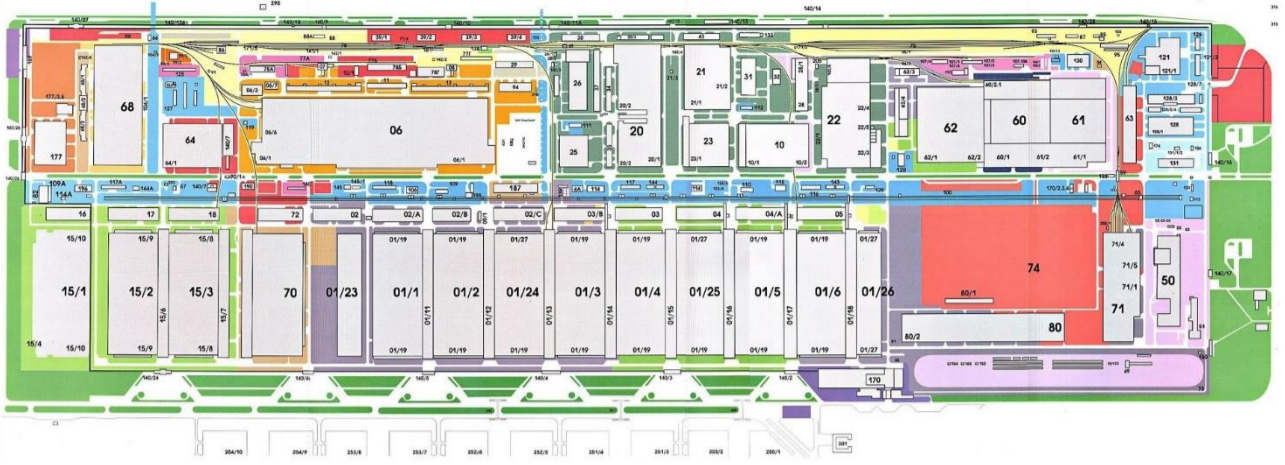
Схема расположения корпуса 15/3 АО «АвтоВаз»
